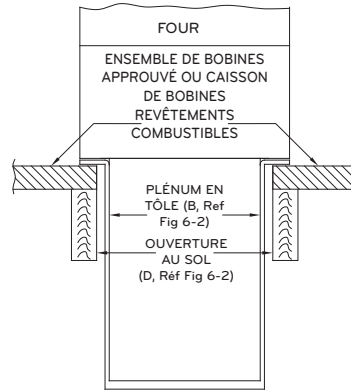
Ensemble fournaise, plènum et serpentin boîte à serpents installés sur un sol combustible
